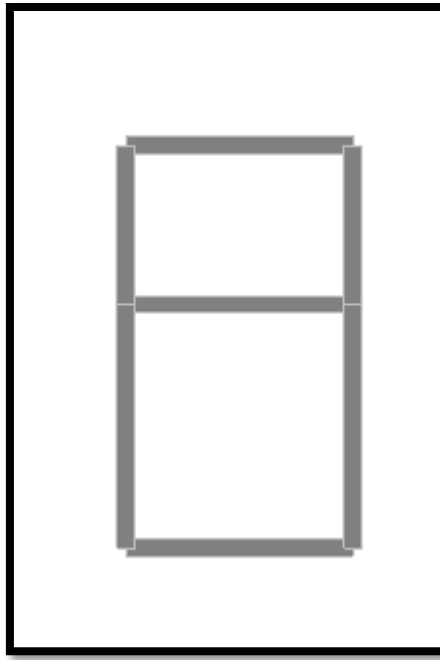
Vérification du ferrailage des poutres principales et des chaînages (Z=9.9 m)
